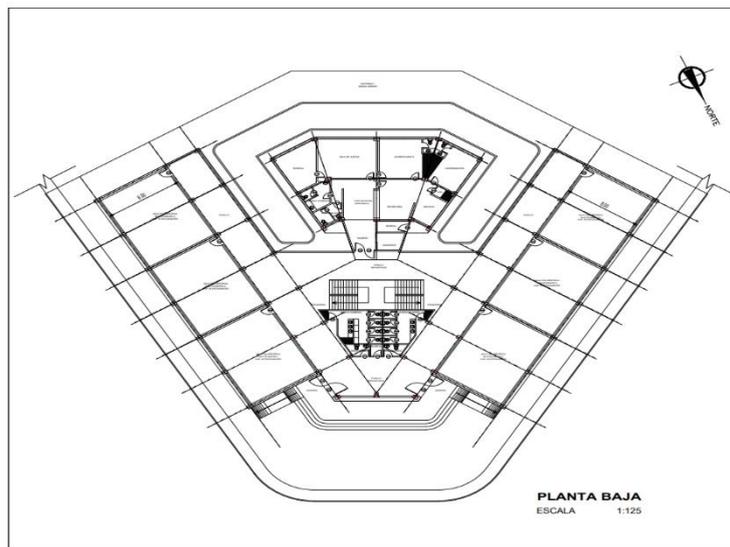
ARQUITECTÓNICO 2D.
